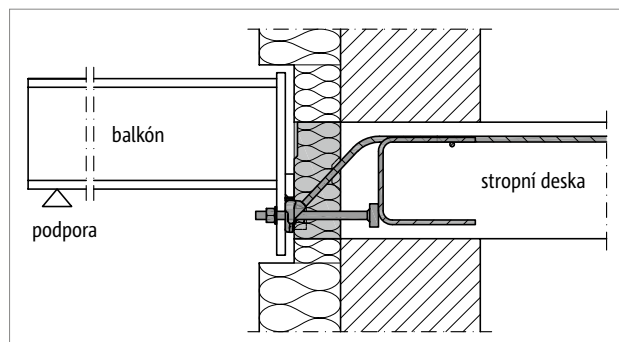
Schöck Isokorb® T typ SQP: Balkón se sloupovými podporami
